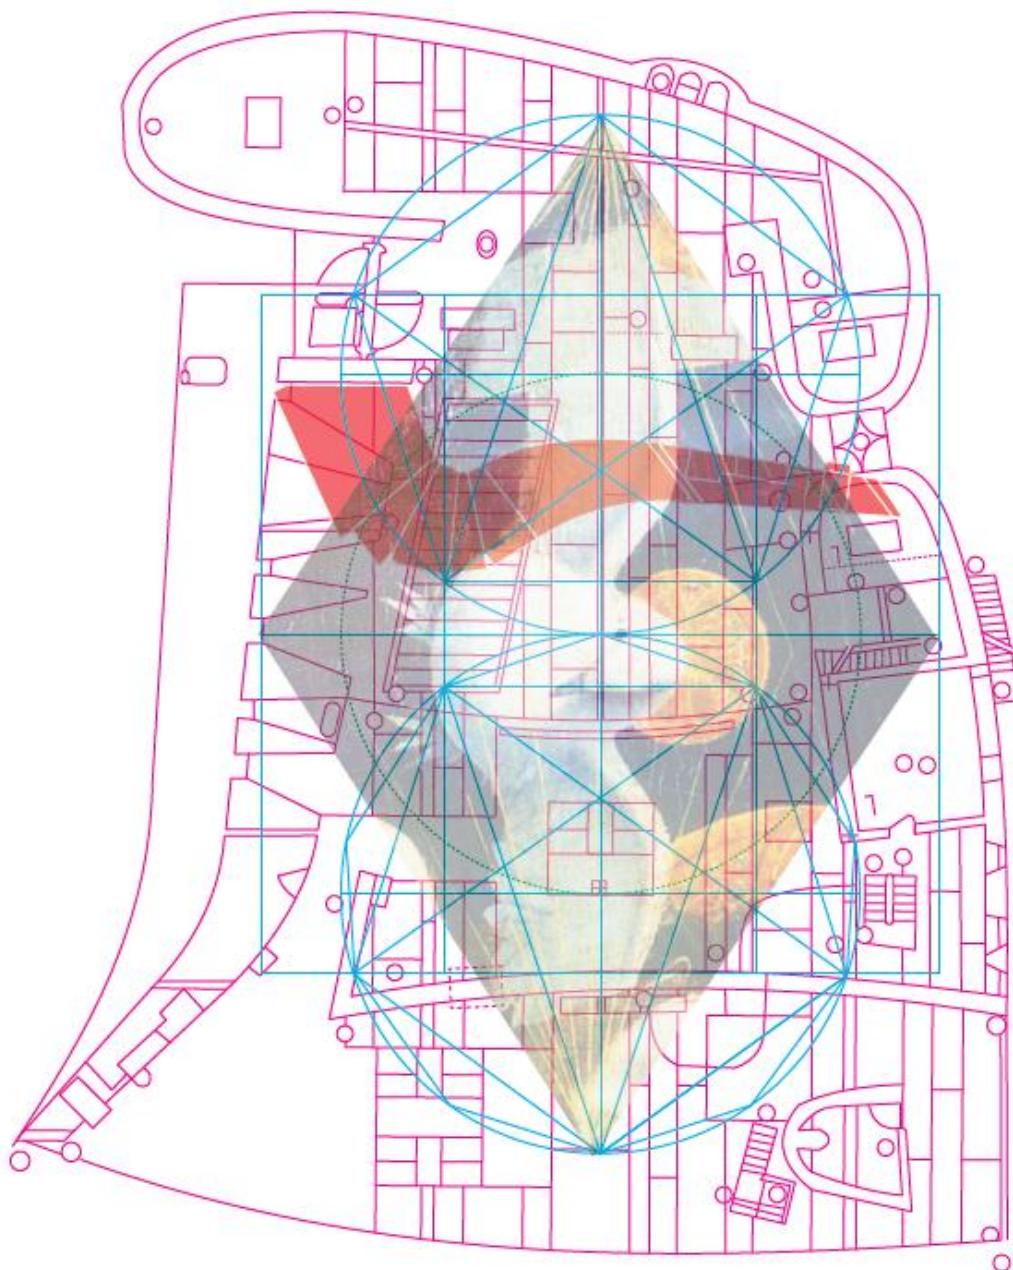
Planimetria con muro sud virtuale e bisettrice dello spazio di Ronchamp, con tracciato regolatore e losanga verticale.
